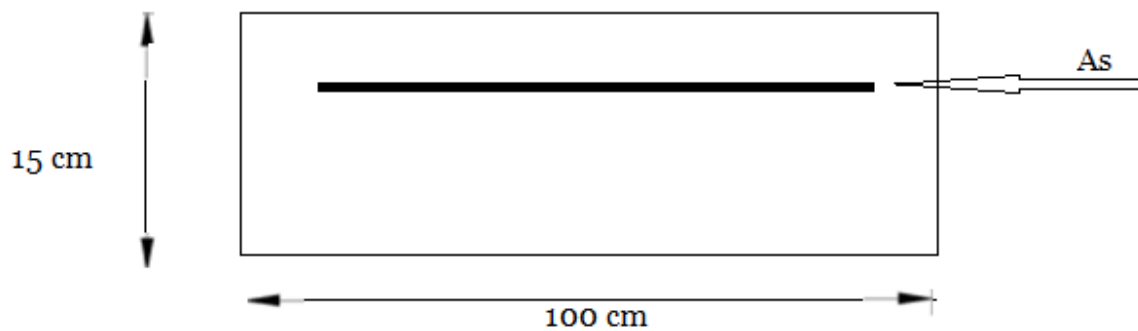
coupe transversale d'un mètre linéaire du balcon .
